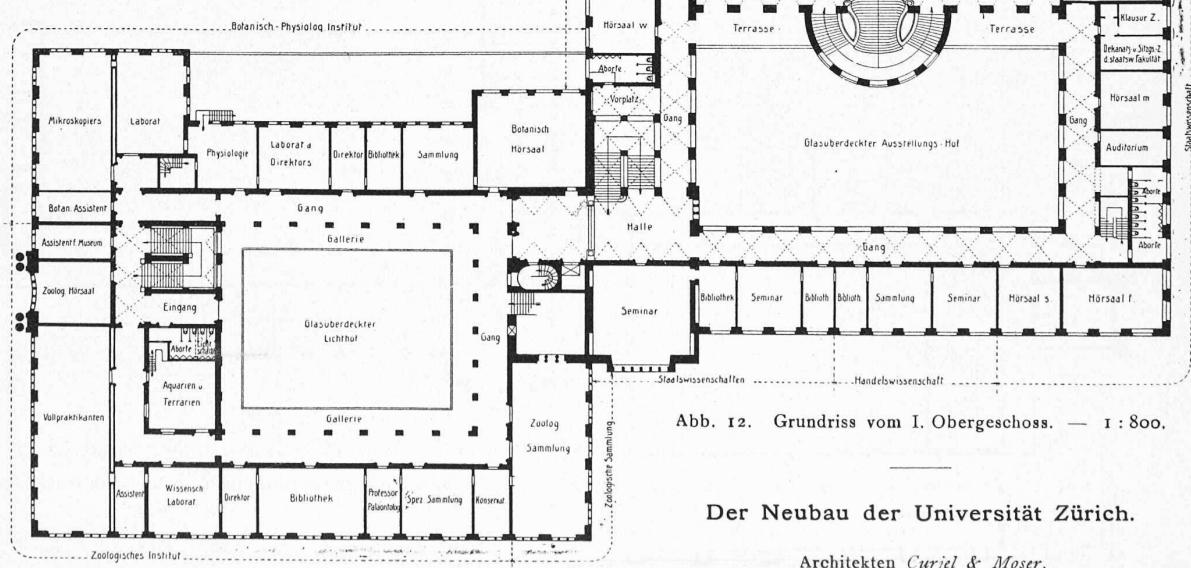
Grundriss vom I. Obergeschoss. — 1:800.
